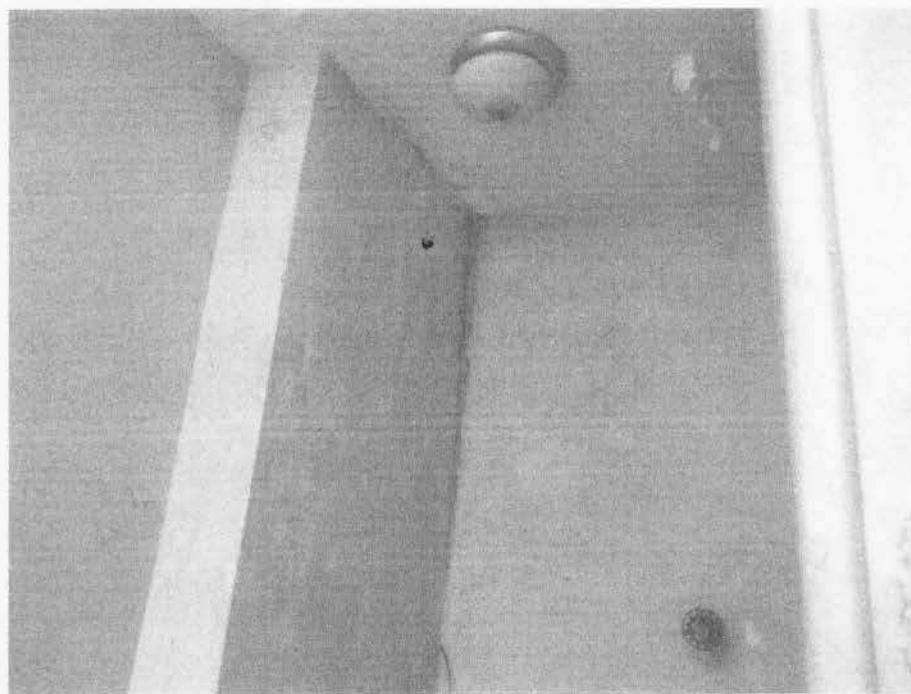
Vista do sanitário do conjunto comercial 2.420, com manchas de infiltração e trincas no teto e paredes.
